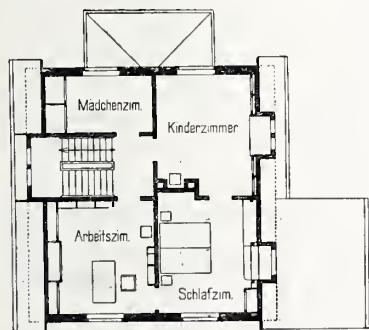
Grundriss vom Obergeschoss des Hauses von Dr. Finckh. — 1:400.
